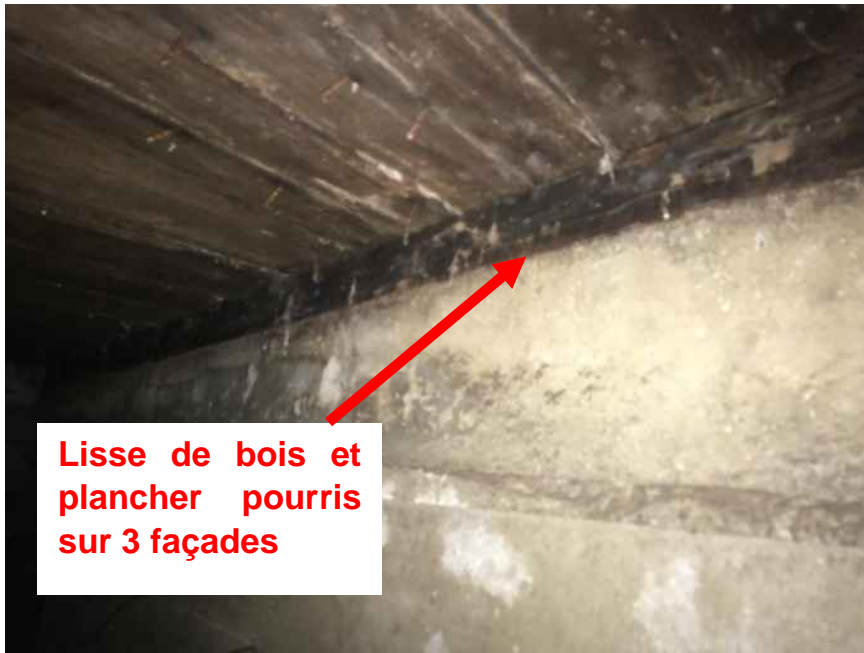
lisse de bois et plancher pourris sur le périmètre des trois façades
